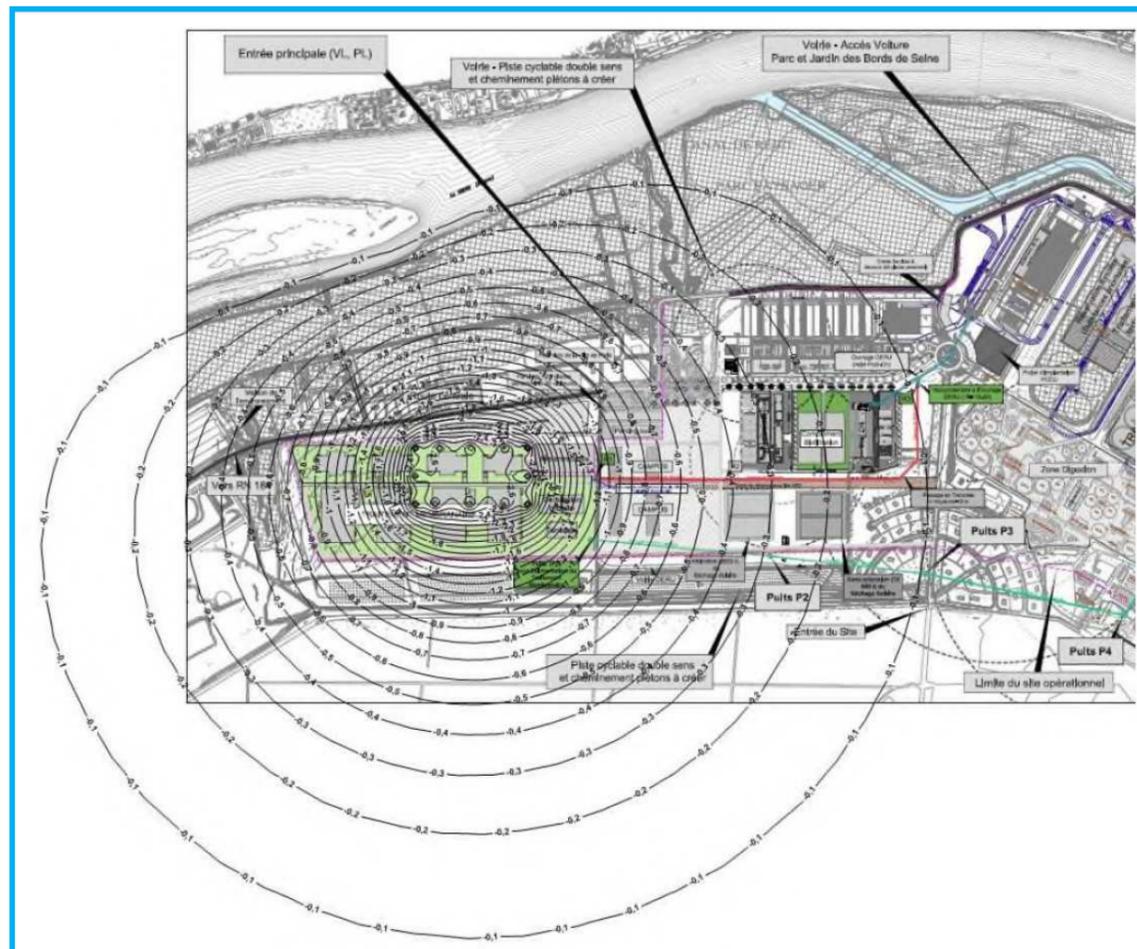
Modélisation du rabattement de nappe à l'objectif 18.5m NGF projeté sur le plan aérien de la future zone membranaire
